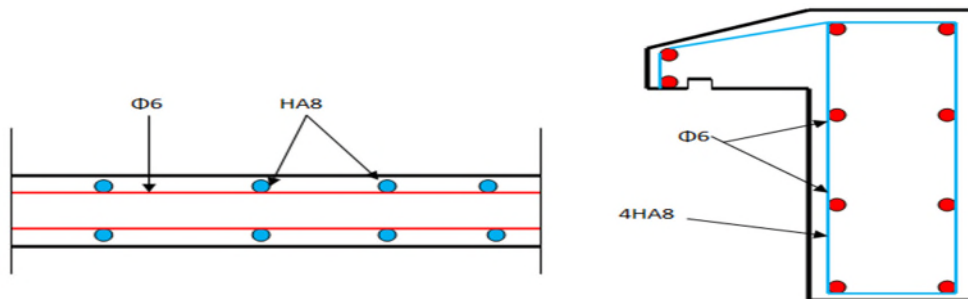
Schéma de Ferrailage de l'acrotère.
